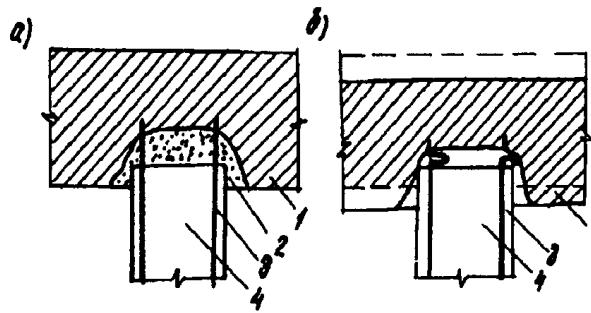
Схема состояний монолитной плиты основания котельной (а — при бетонировании; б — после того как растаял лед, оставшийся в опалубке):
